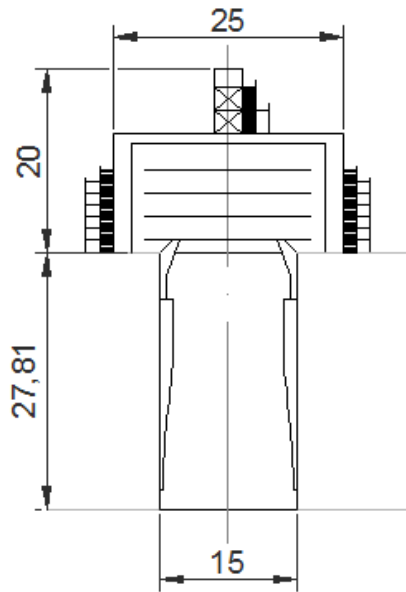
Medidas cuerpo estructural y superestructura de la torre, vista frontal (Fuente propia)
